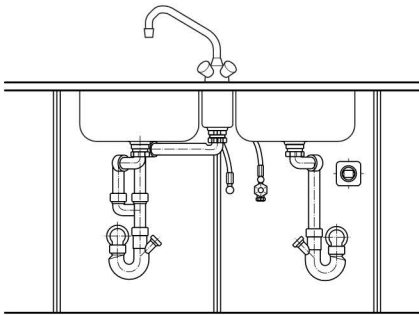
Spültisch mit zwei Becken und einem Ausguss
